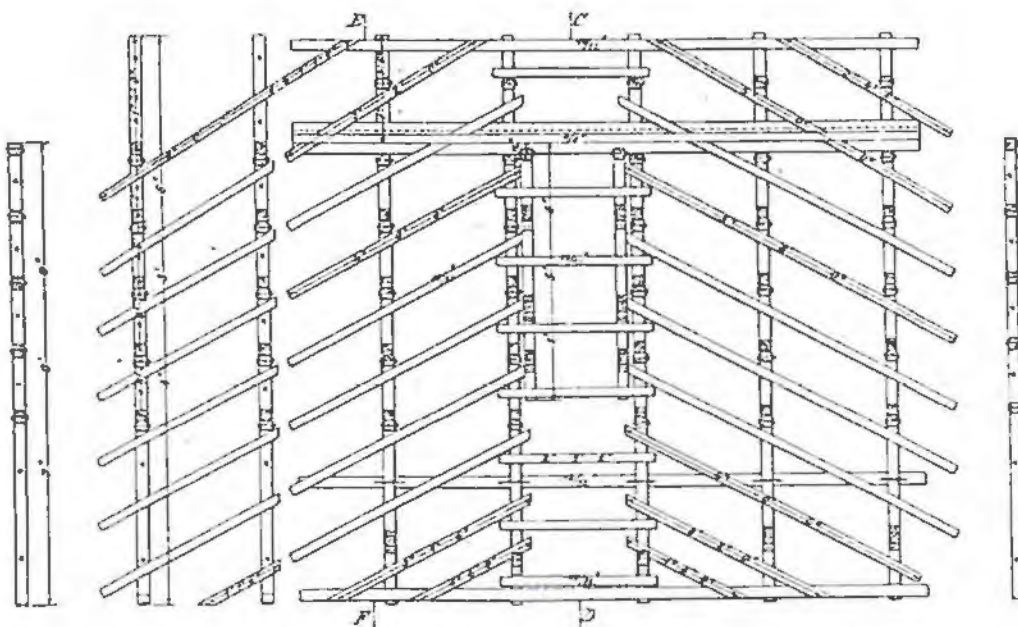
Die Schwarzaklause im Wirtschaftsbezirke Reichraming (Grundriss).
